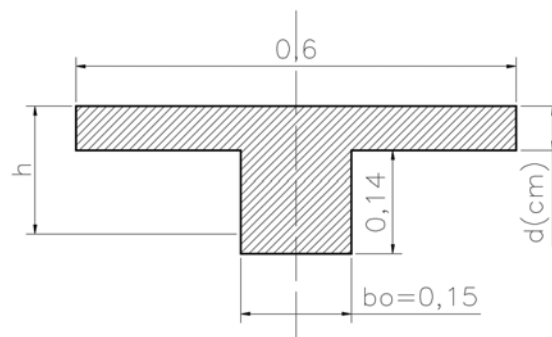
Esquema de viga T o Viga placa según DIN 4158
